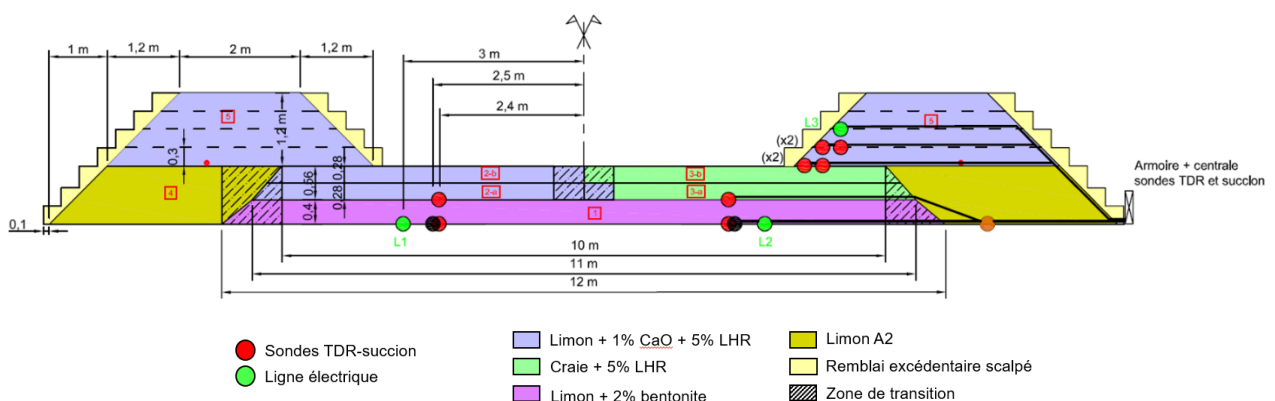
Coupe du bassin et schéma d'instrumentation des planches d'essais.
